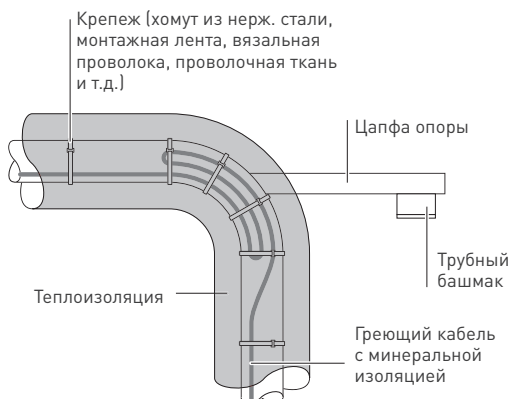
Монтаж греющего кабеля поверх опорных колодок
